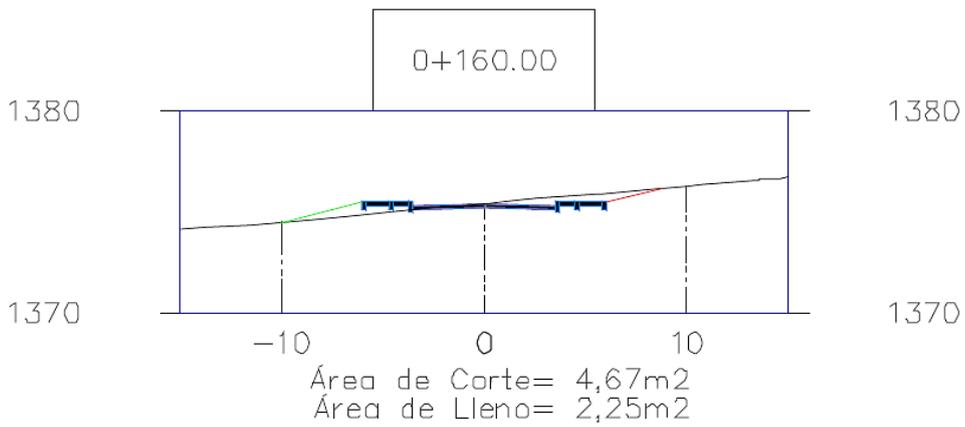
Sección Transversal, abscisa 0+160. Elaboración Propia
